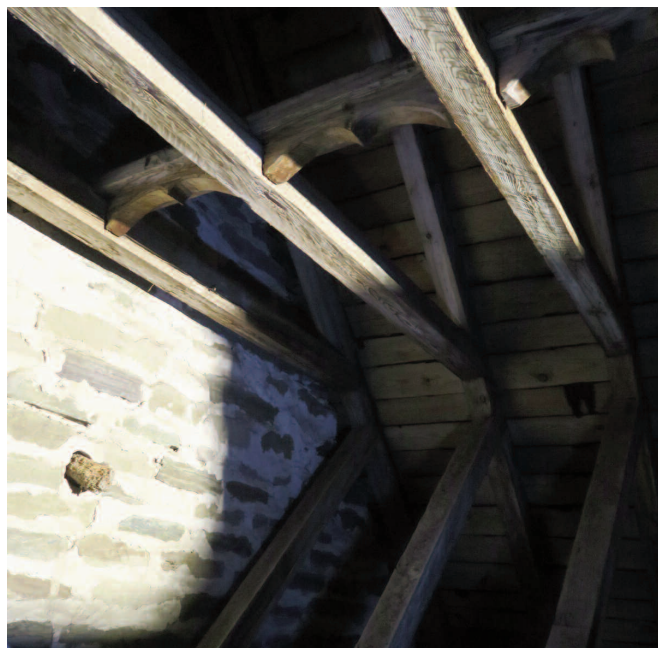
Korets taklag med dekorativ styrplanka och rest av möjligt inmurat ställningsvirke. Foto förf.
